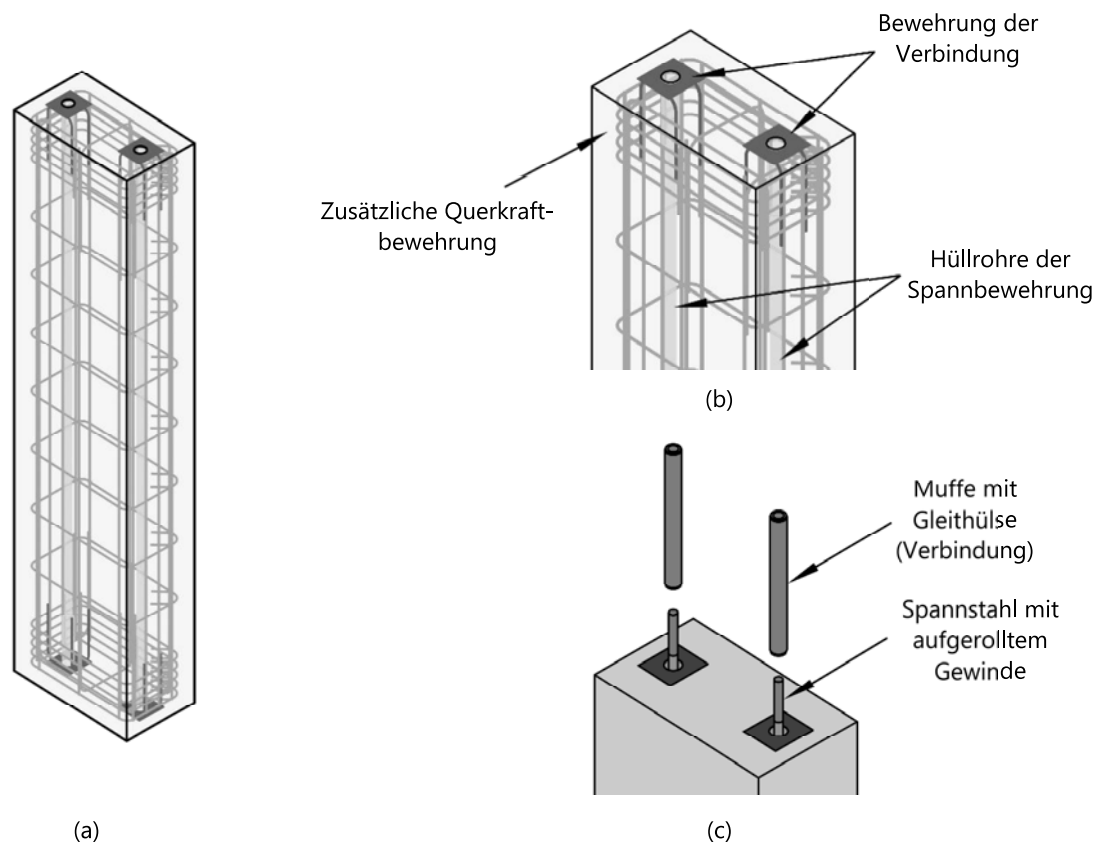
(a) Vereinfachtes Tragelement mit Schnittstellen und Bewehrungsführung, (b) Detail: Schnittstelle, (c) Explosionszeichnung: Spannstäbe und Muffenkopplung
